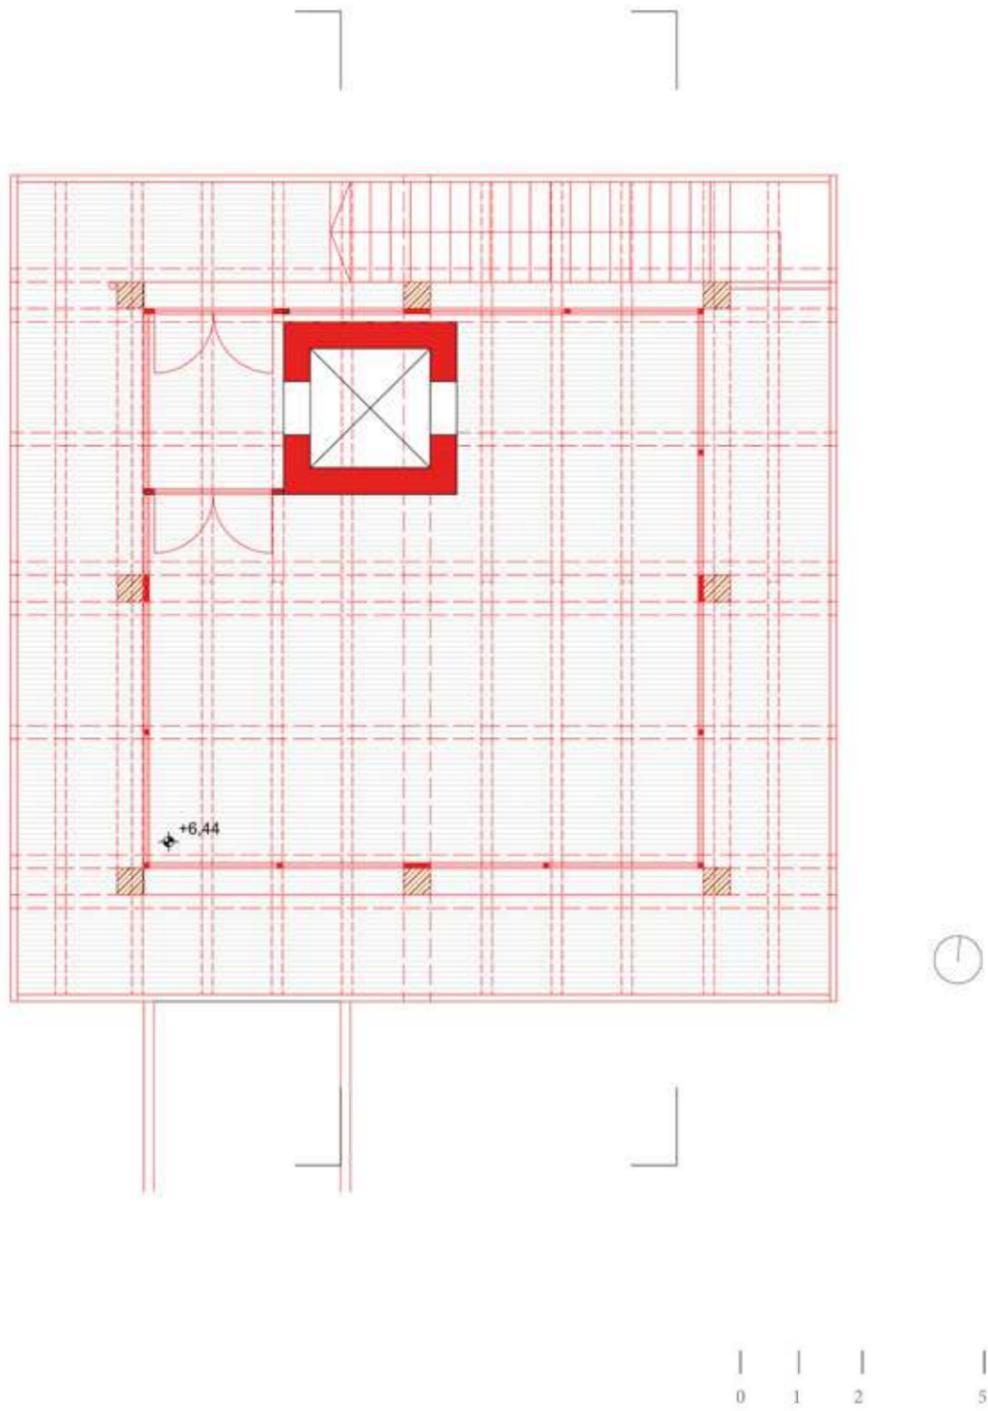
Grundriss 2. Obergeschoss Jagdkanzel, M 1:100
